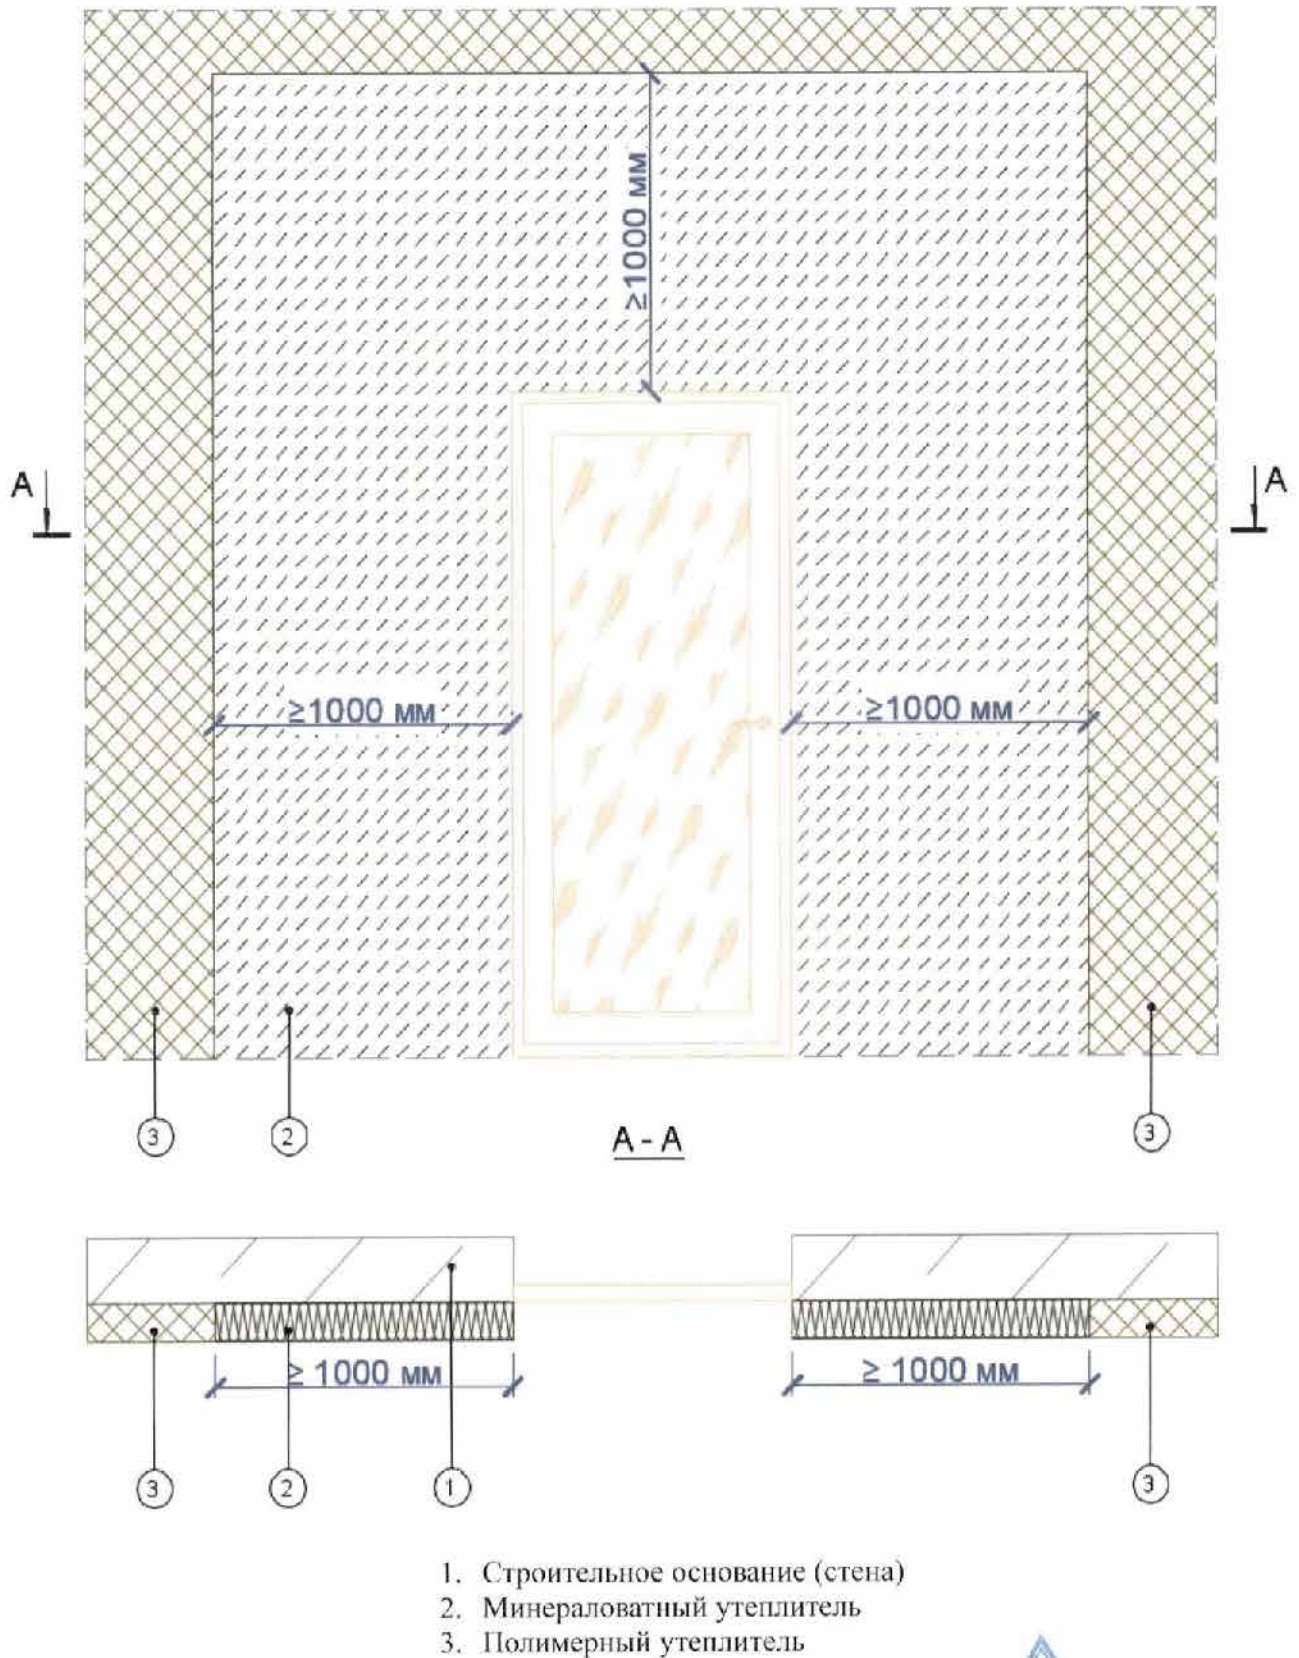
Участки наружных стен по периметру эвакуационных выходов из здания
